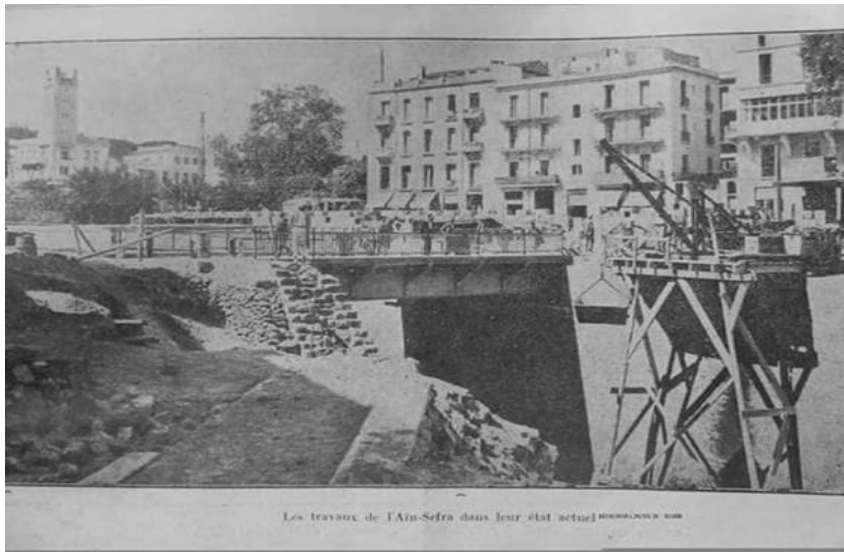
travaux sur Ain Safra, chantier de reconstruction d'immeuble
